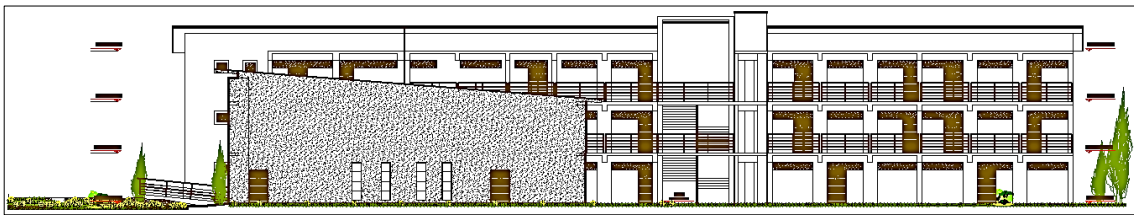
Vista frontal del Pabellón de Turismo y Hotelería (Fuente: Planos de elevación)
